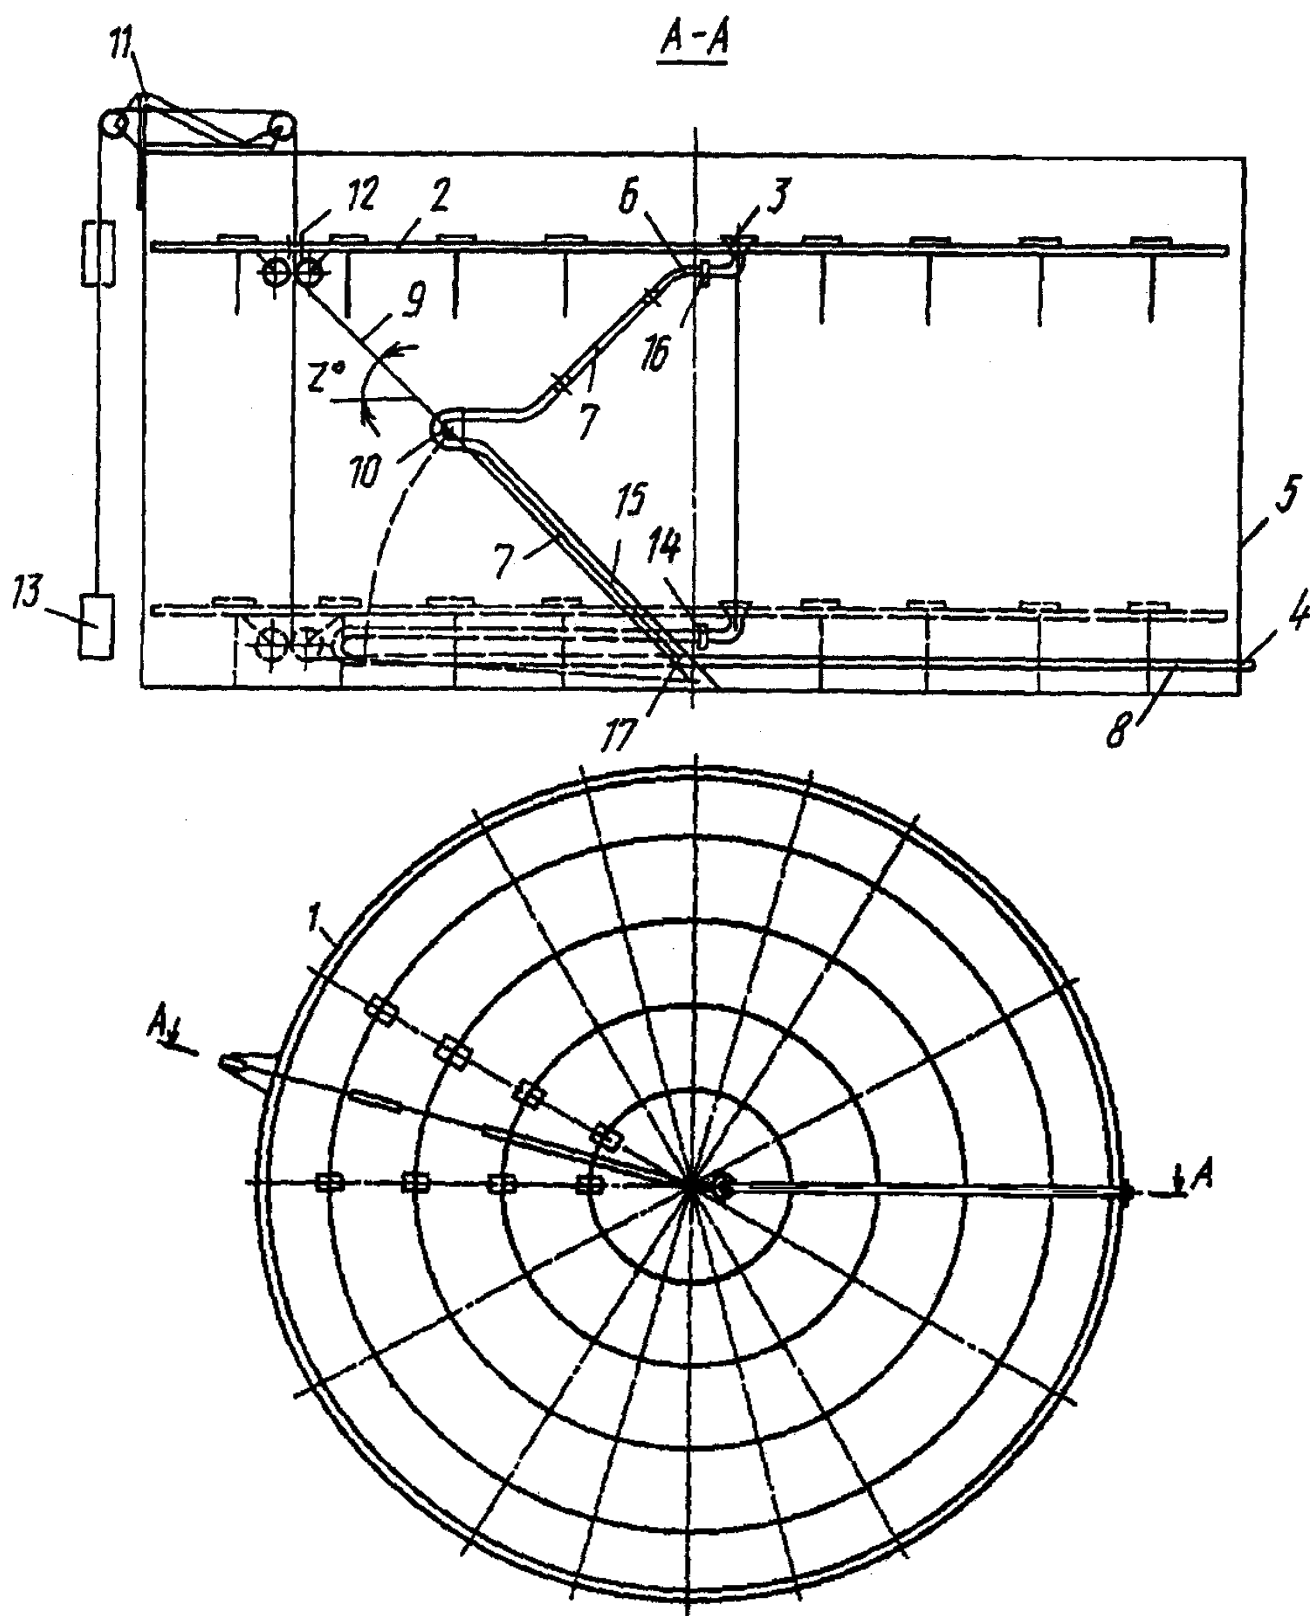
Конструктивные схемы водоспусков с расположением устройства снаружи резервуара
